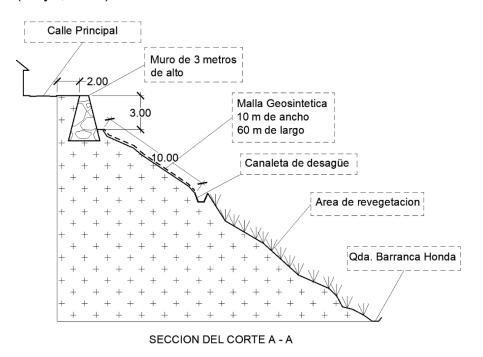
Vista de perfil de las obras (mayo, 2021).
